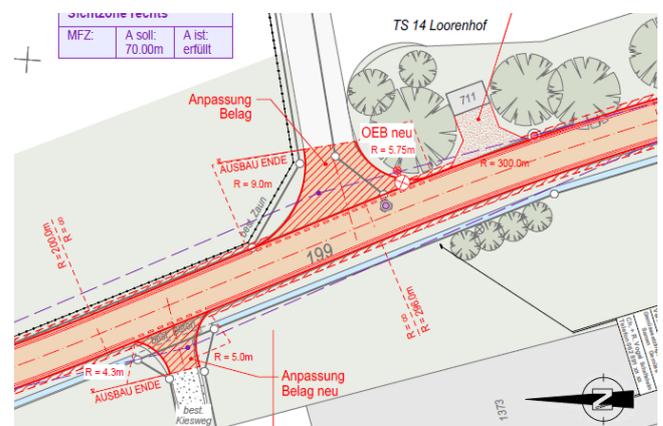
Planausschnitt aus dem Strassenbauplan – Bereich Knoten Looren
